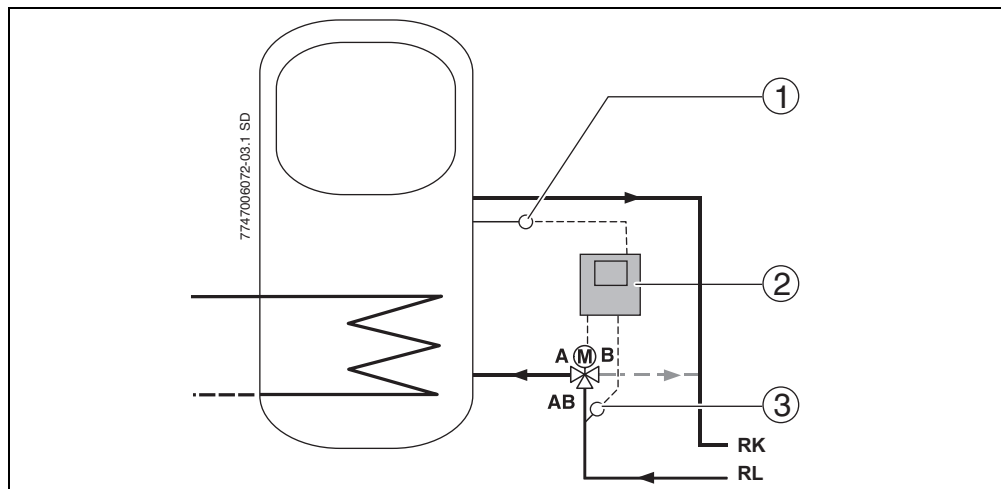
Schemă de montaj, ridicare pe retur, boiler combi
